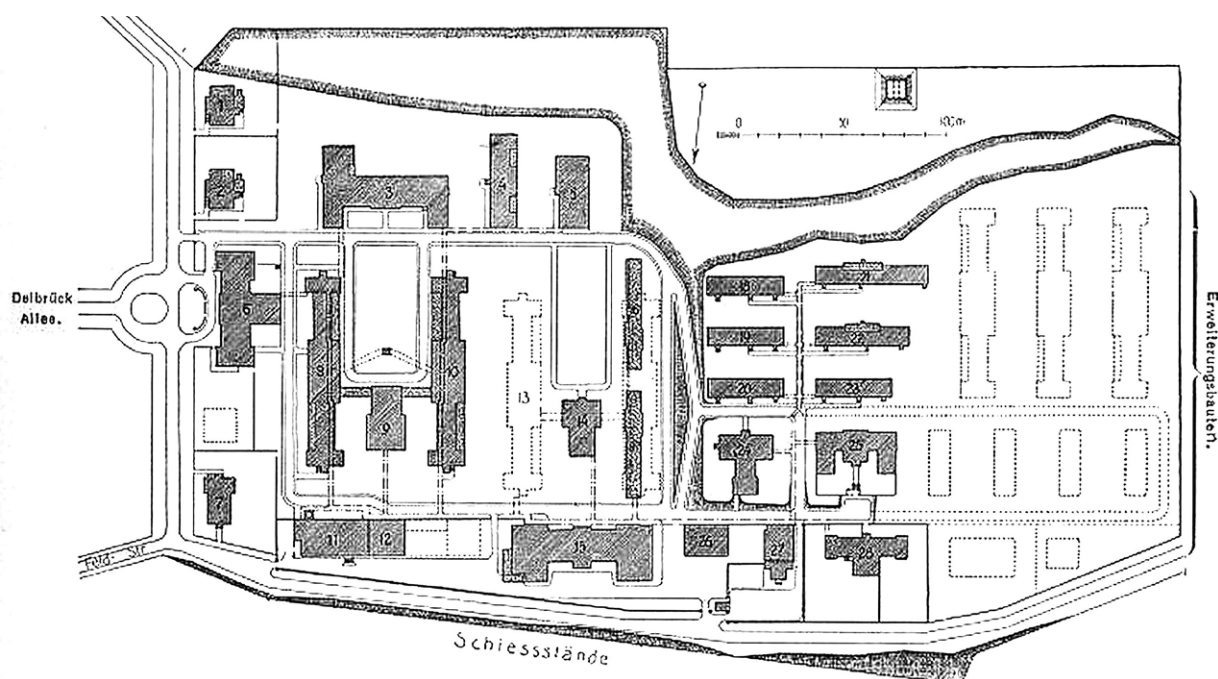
Neue städtische Krankenanstalt. Lageplan.
